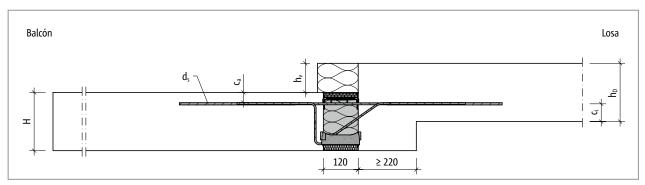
Schöck Isokorb® XT tipo K: Menor desplazamiento de altura hacia abajo (balcón más bajo)
